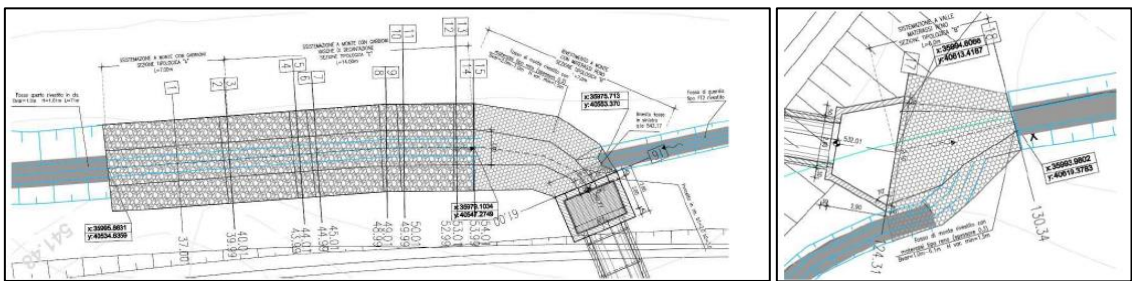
Stralcio planimetrico inalveazione a monte e a valle
